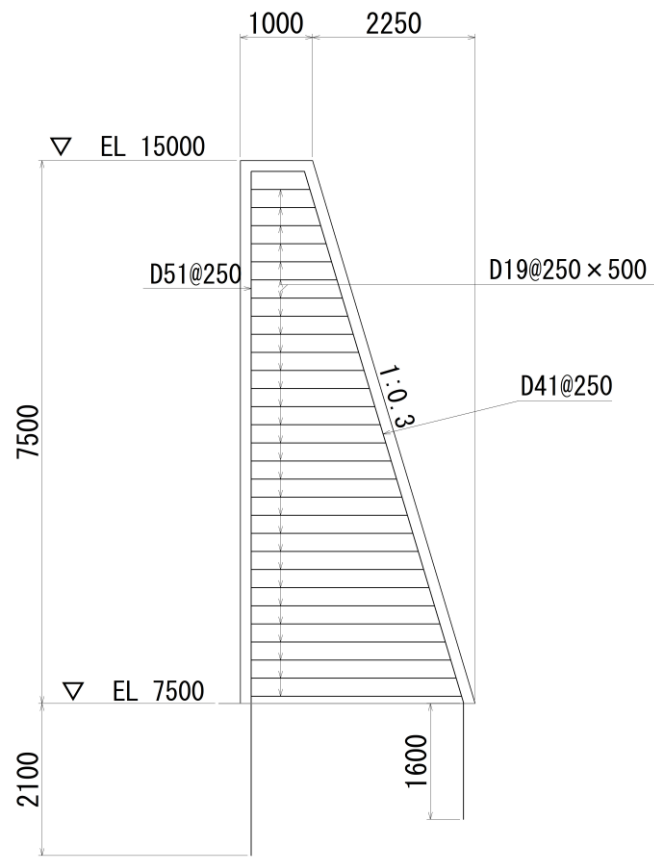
防波壁（波返重力擁壁）の概略配筋図（⑤-⑤断面）
